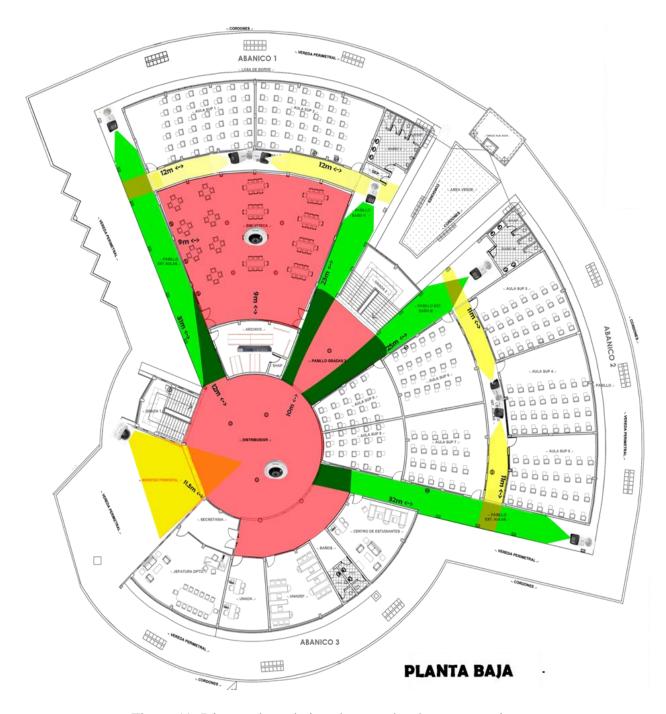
Diseño planta baja cobertura de cámaras y equipos
